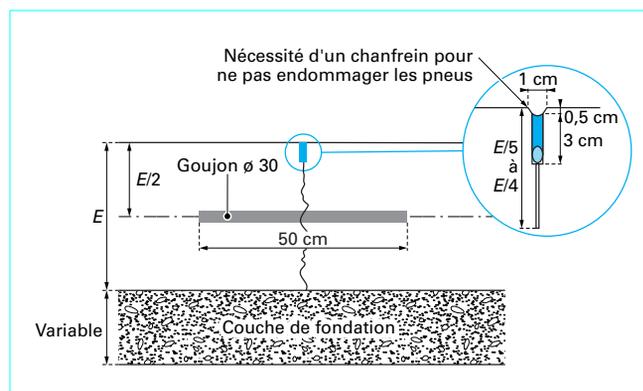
Dalles goujonnées : coupe longitudinale au niveau d'un joint de retrait, en chaussées aéronautiques
